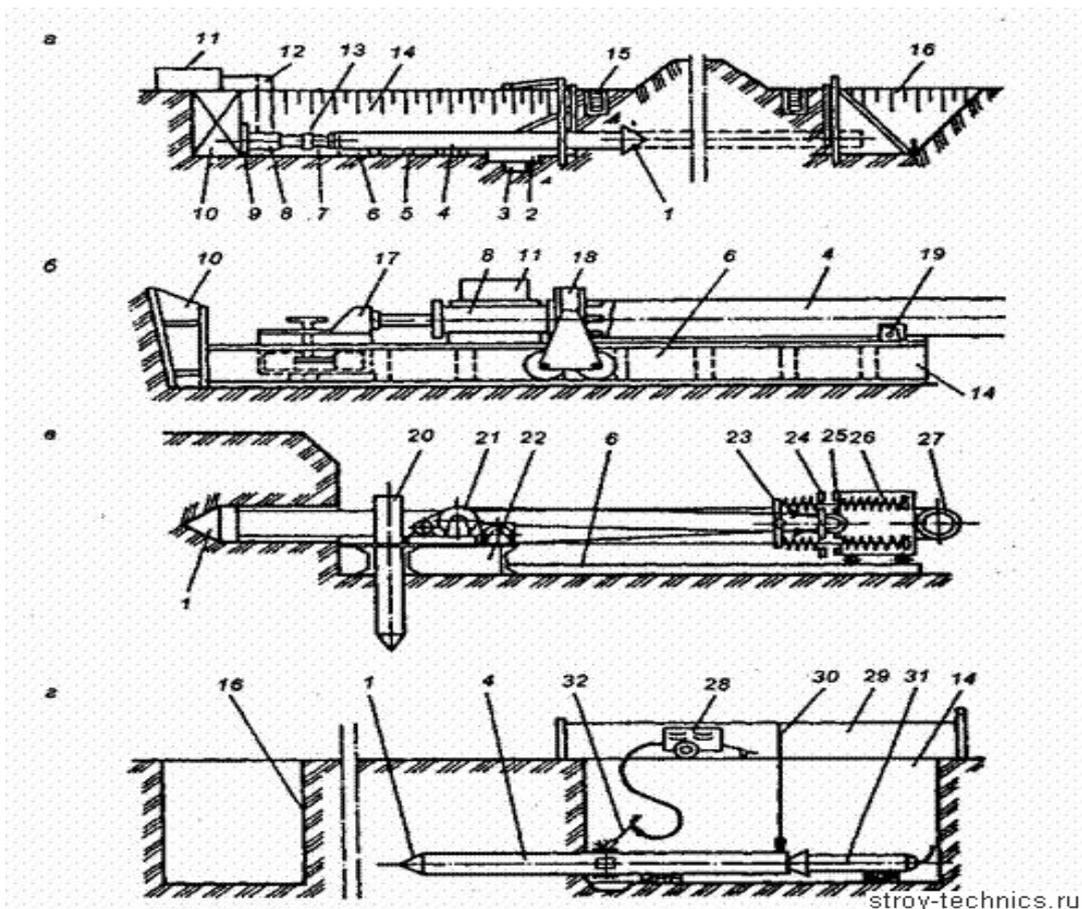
Способы прокола труб: а — общая схема работ; б — прокол установкой ГПУ-600; в — вибропрокол установкой УВВП-400; г — прокол труб с помощью пневмопробойников; 1 — наконечник; 2, 3 — прямки; 4 — прокалываемая труба; 5 — шпалы; 6 — направляющая рама; 7 — нажимной патрубок; 8 — гидродомкраты; 9 — опорный башмак; 10 — упорная стенка; 11 — насосная станция; 12 — маслопроводы; 13 — нажимная заглушка; 14, 16 — рабочий и приемный котлоуны; 15 — обводной лоток; 17 — подвижный упор; 18 — нажимная плита на тележке; 19 — фиксатор; 20 — свая; 21 — лебедка; 22 — рама; 23 — планка; 24 — ударная приставка; 25 — направляющие стержни; 26 — вибрационный механизм; 27 — электродвигатель; 28 — электросварочный агрегат; 29 — причалка; 30 — отвес; 31 — пневмопробойник; 32 — сварка труб
